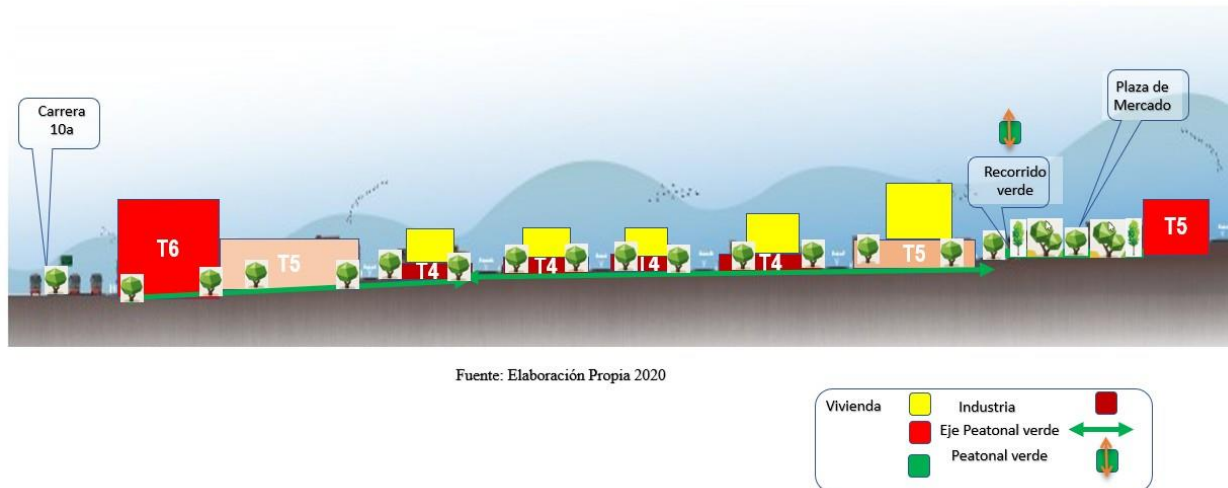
Planta-Propuesta de nuevo transecto recorrido carrera 5a
